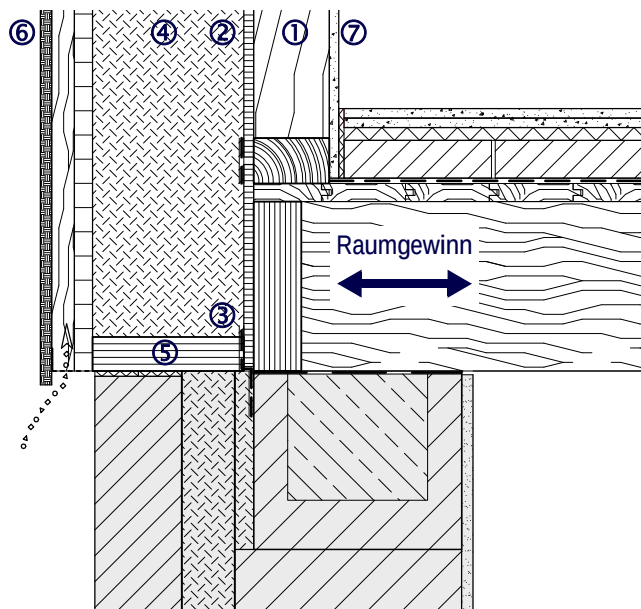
Wie Abb. G3.10, jedoch mit einer Fertigteil-Deckenkonstruktion aus Holzmassiv-elementen.
